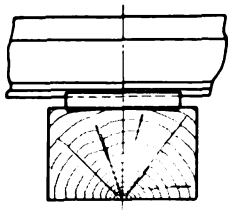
Einpressung in der Schwelle bei gewöhnlicher Hakenplatte.
